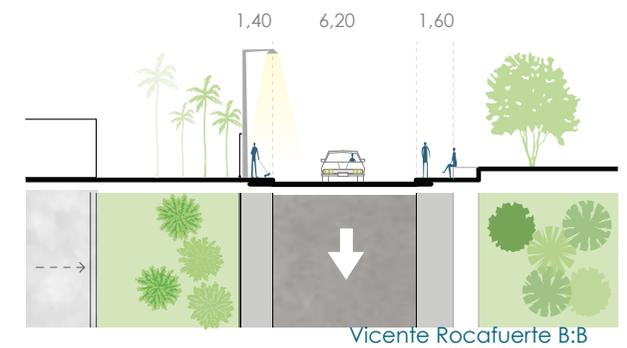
Secciones Viales. Fuente: Elaboración Propia
